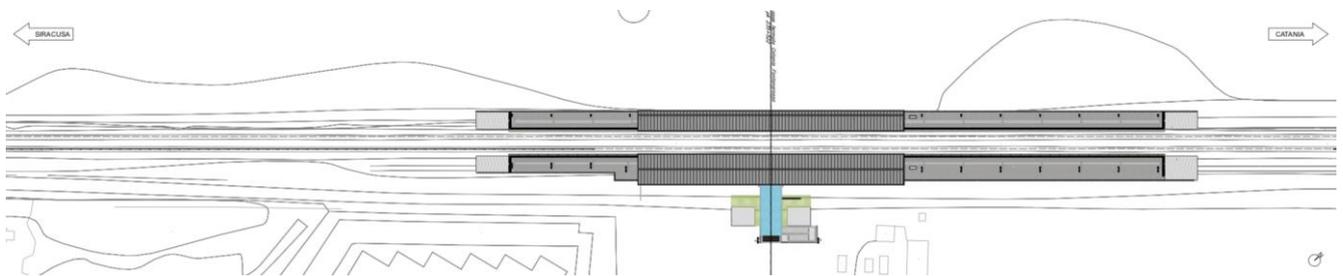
Planimetria generale ante operam - Fermata Fontanarossa
